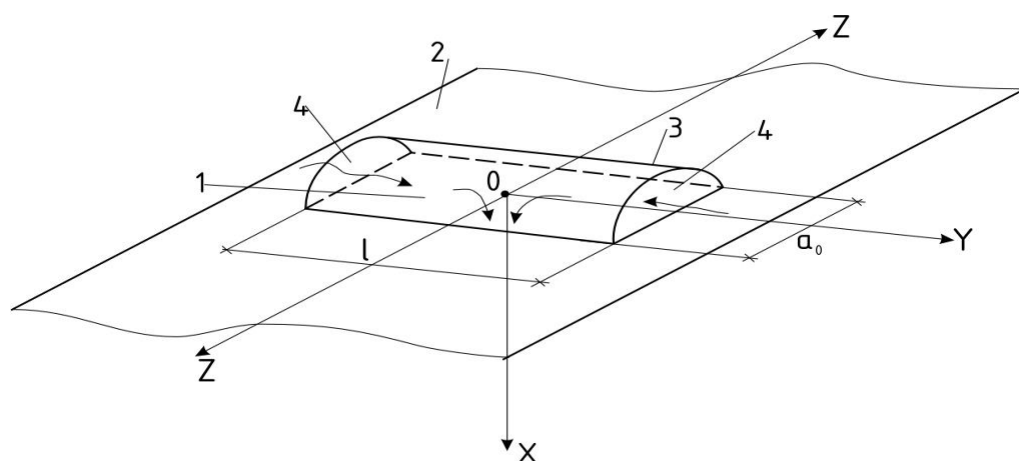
Общий вид лункообразного воздухораспределителя: 1 – прямоугольное отверстие; 2 – стенки воздуховода; 3 – полуцилиндрический экран; 4 – оппозитные отверстия
